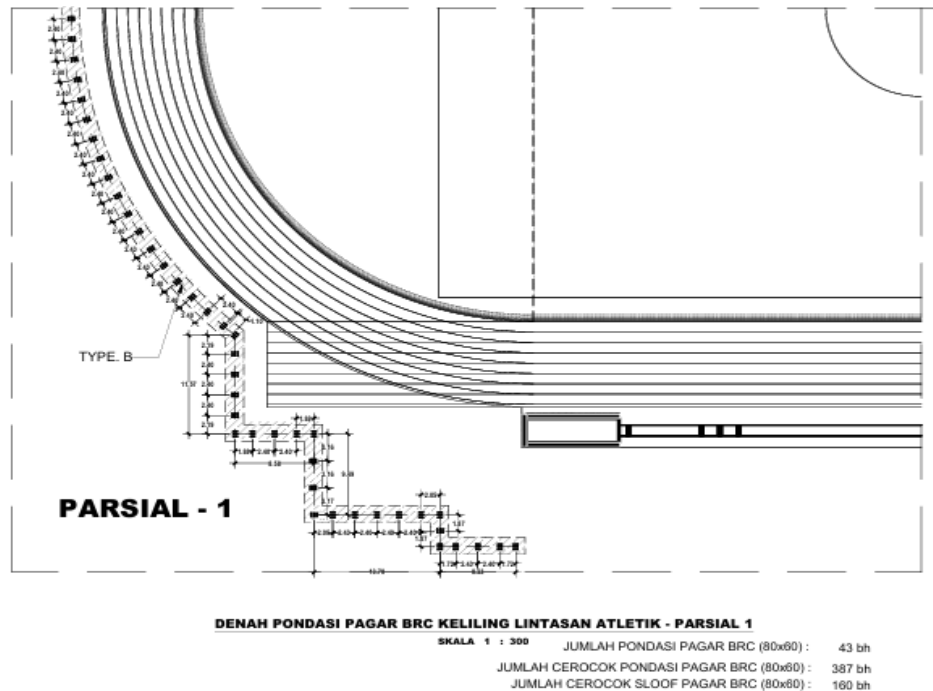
17 Gambar denah pondasi pagar BRC keliling lintasan atletik
